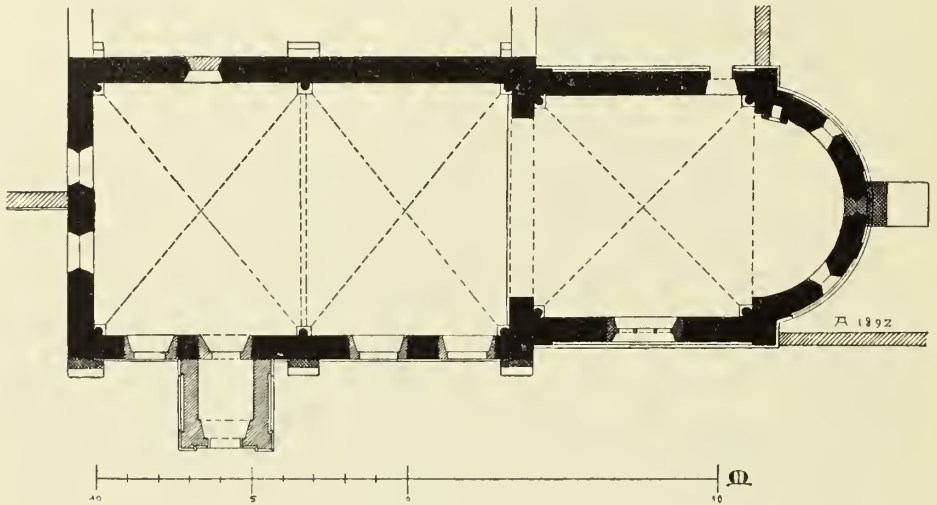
Saarn. Grundriss der Klosterkirche.
